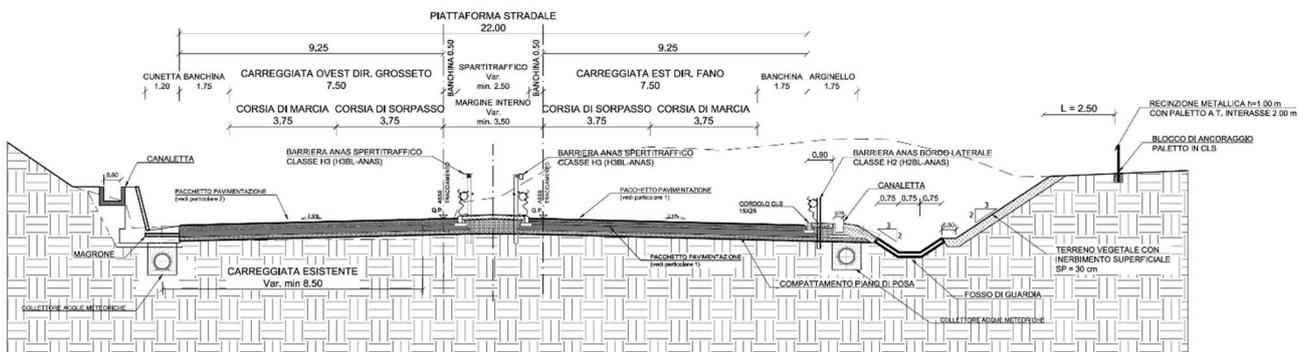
Sezione tipo in trincea in rettilineo con scavo laterale e muro a margine
